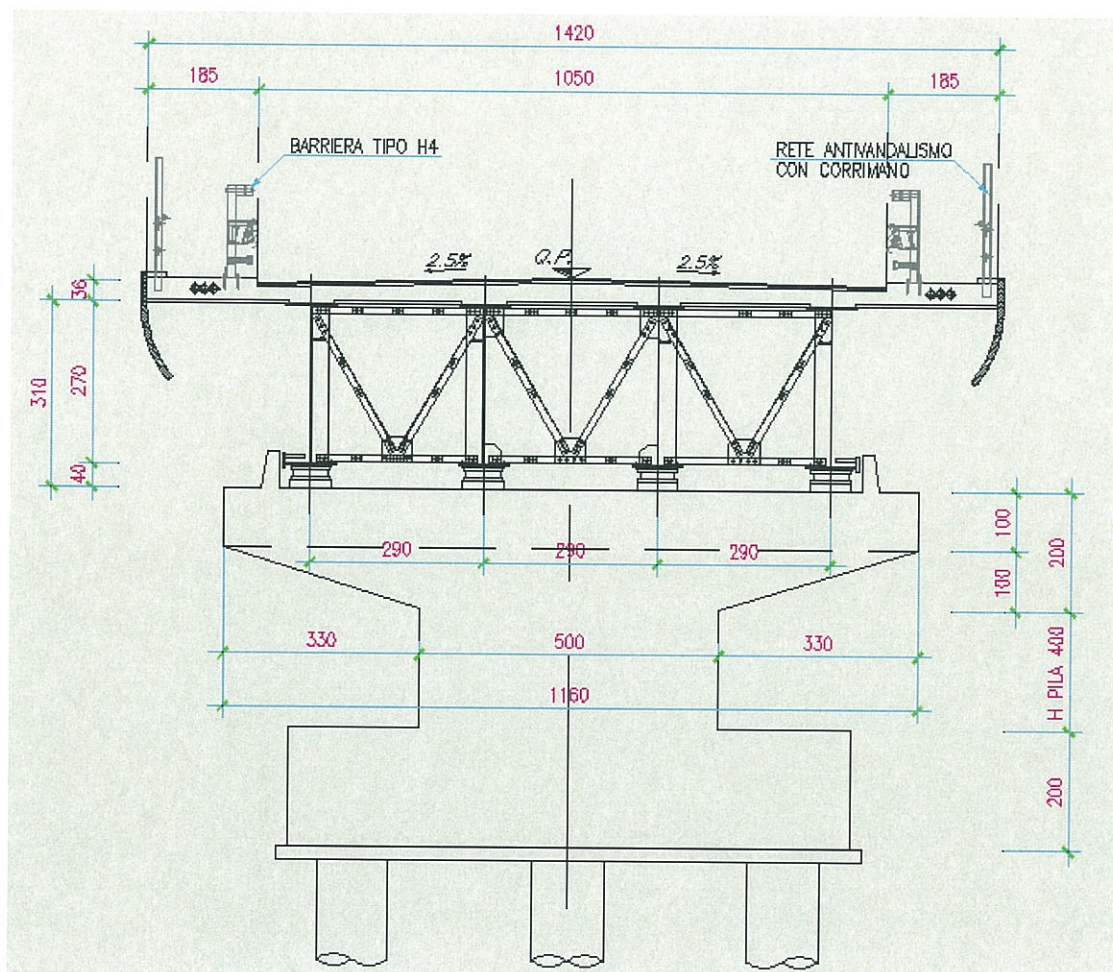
Ponte sul Collettore principale - sezione trasversale.
